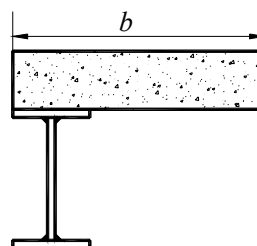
Largura efetiva b quando a laje se estende para apenas um dos lados da viga
